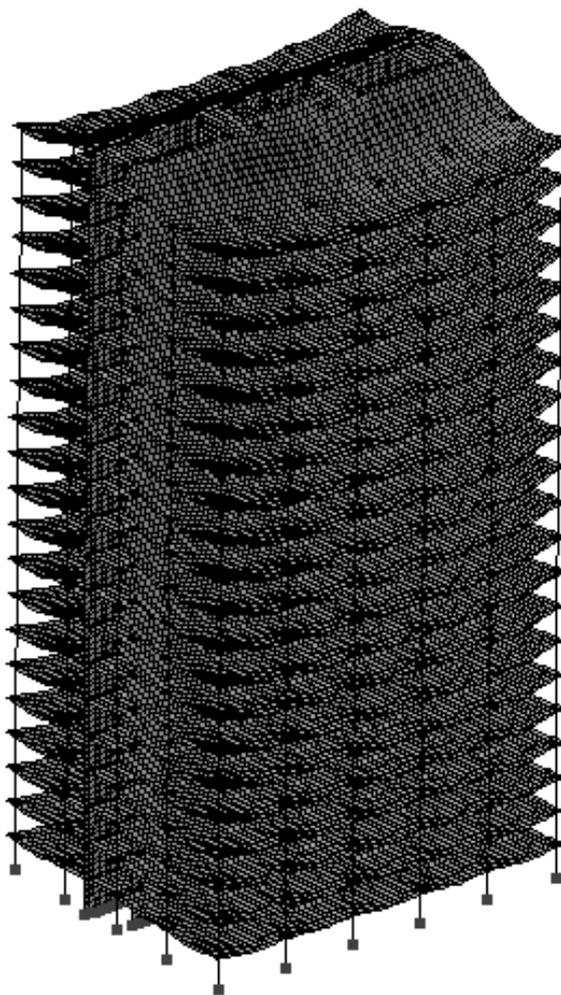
Деформация расчетной схемы от нагрузок
